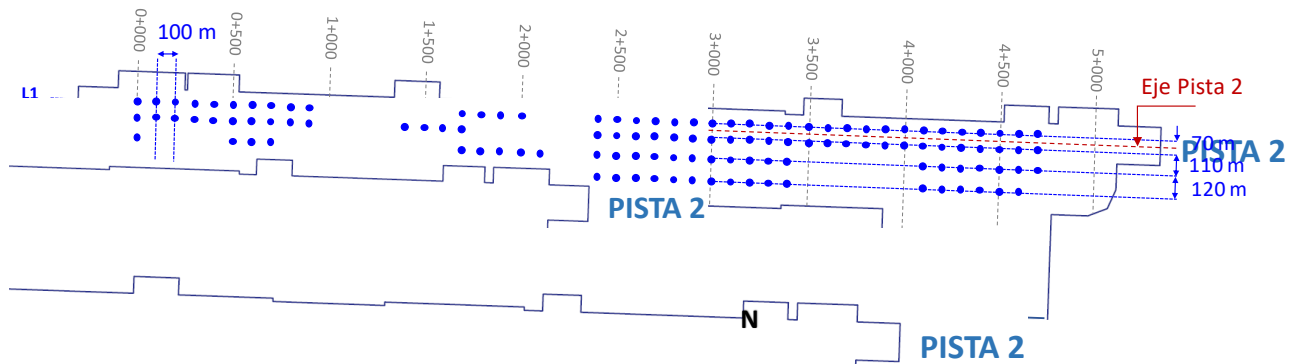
Ubicación en planta de pozos de bombeo en la Pista 2 del NAIM.
